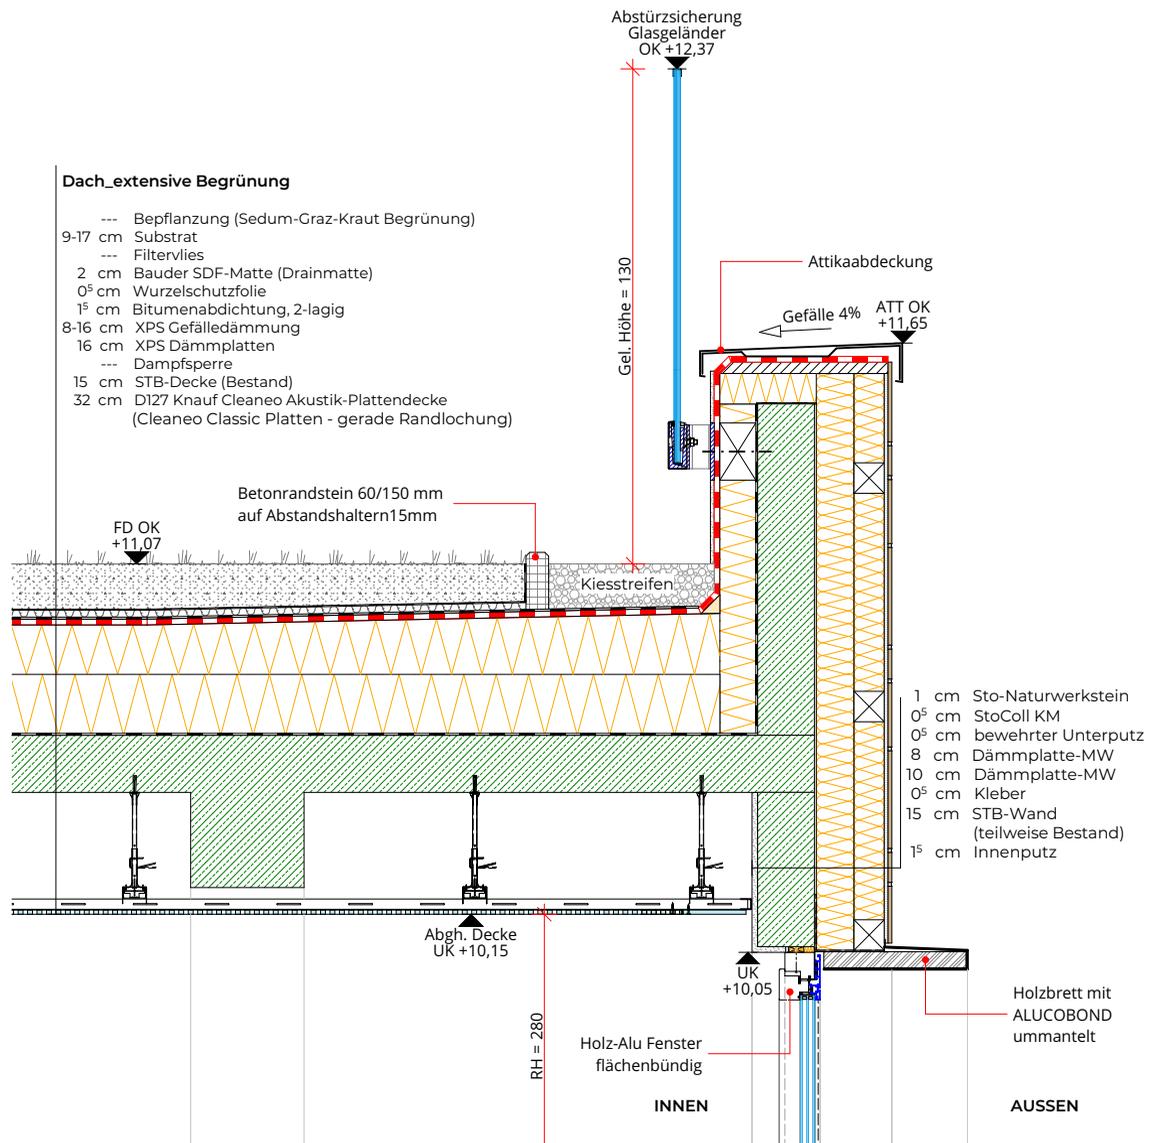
D05_Flachdach extensiv begrünt - Anschluss Attika mit Glasgeländer (Abstürzsicherung)
